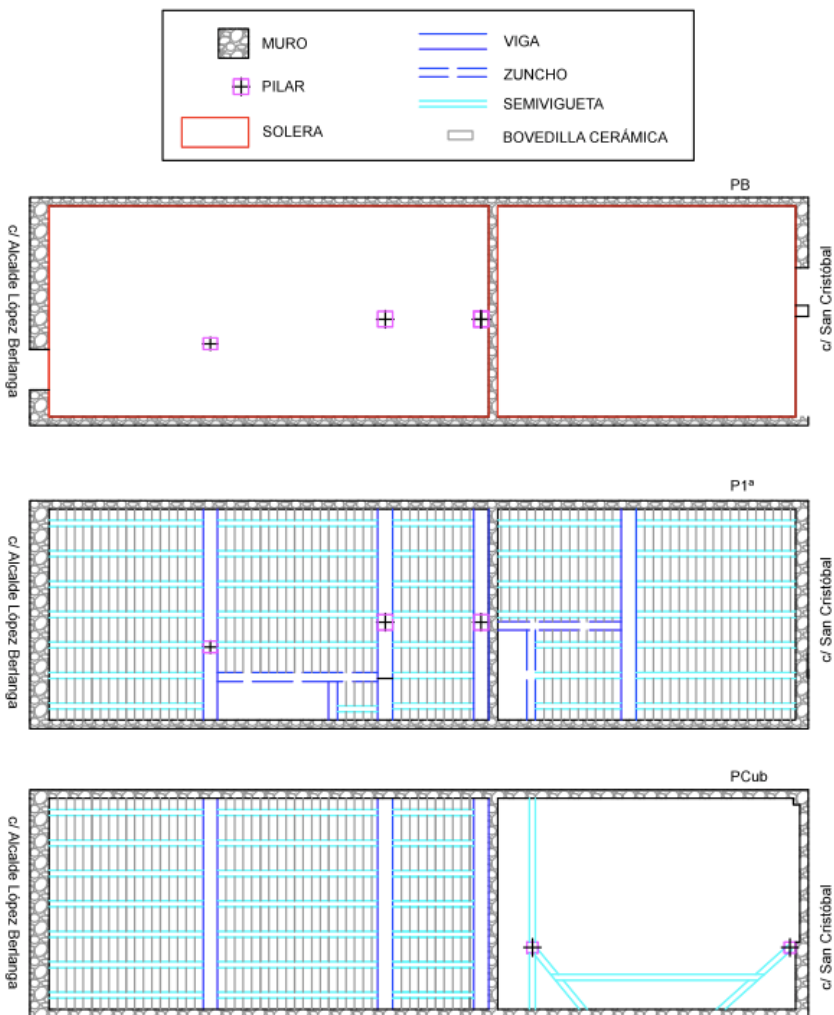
Análisis estructural de la vivienda. Fuente propia.
